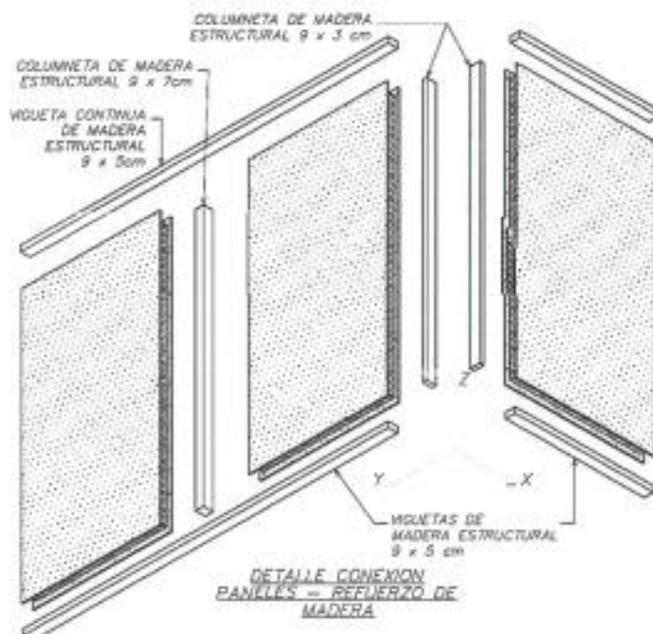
Ubicación del refuerzo de madera estructural – sistema constructivo SIP PANEL TECHNOLOGIES
